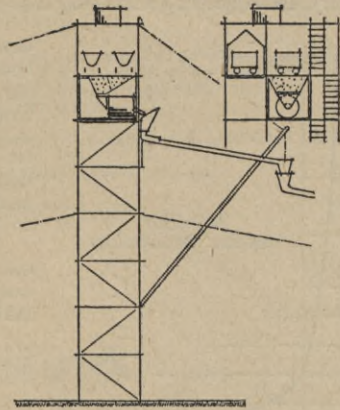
Typy wież rozdzielczych dla betonu lanego.
